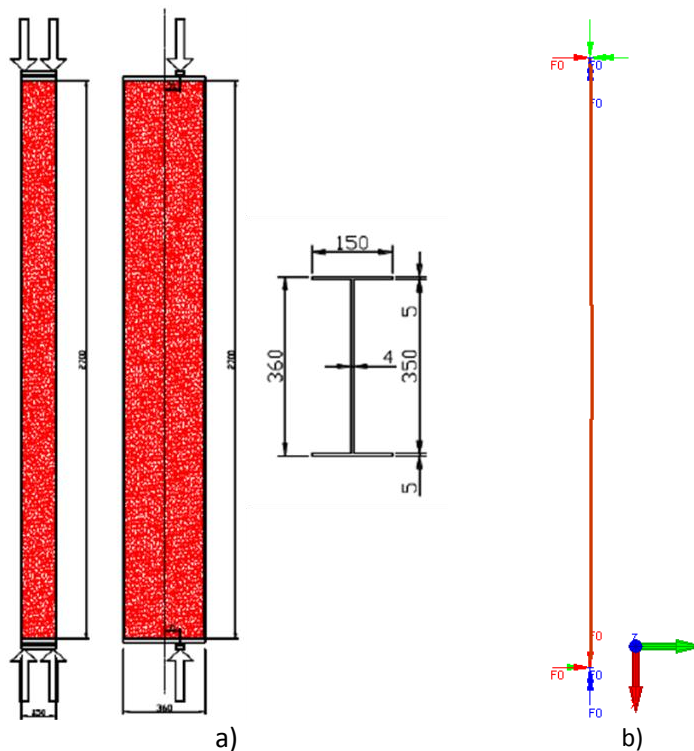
a) Pilar de secção constante sujeito a flexão composta; b) Modelação numérica do pilar de secção constante com elementos finitos de viga pelo SAFIR
